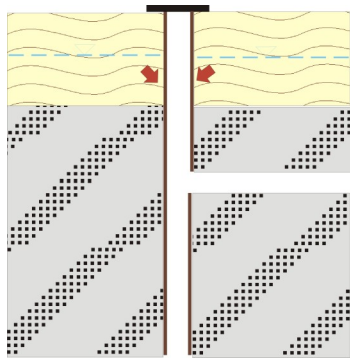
rupture de la dalle de couverture et / ou des parois d'un puits.
